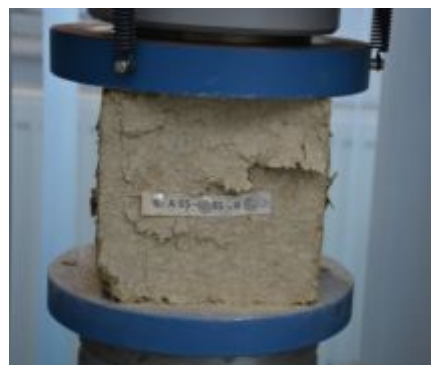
Probe A-V-R. După încercarea la compresiune.
